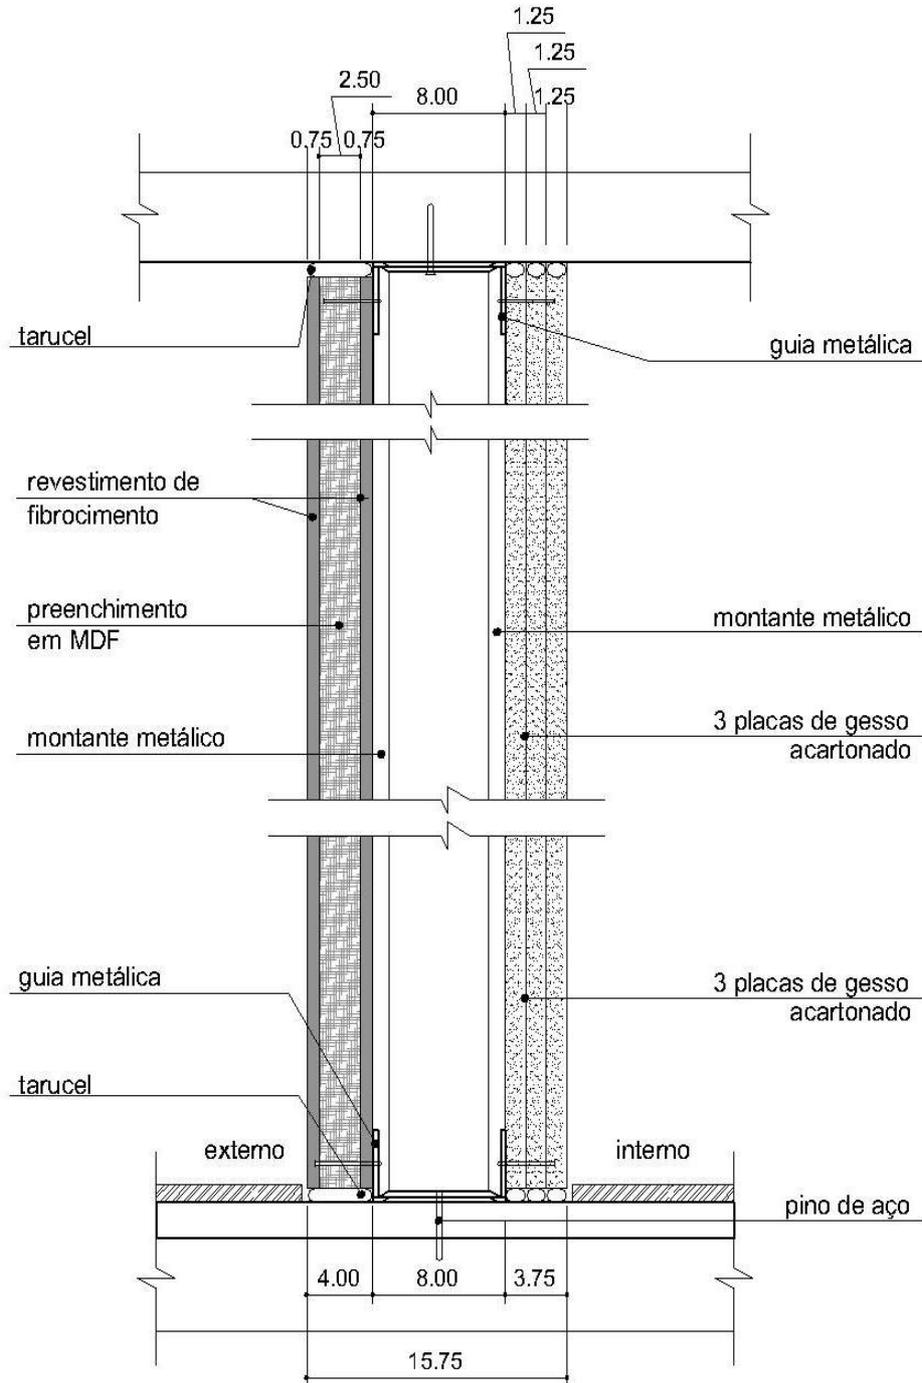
Detalhamento Construtivo do Sistema *steel framing* com placas de gesso internas e placa cimentícia externa: Corte Vertical
